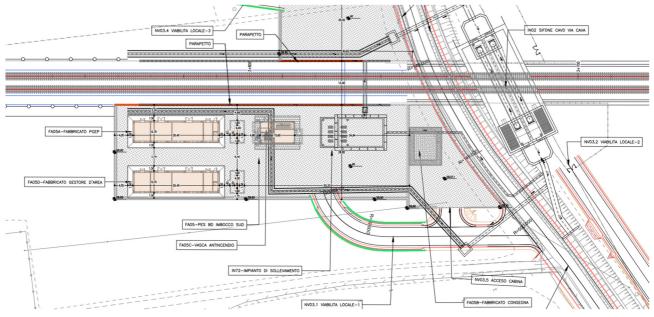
PLANIMETRIA DI PROGETTO FA05
